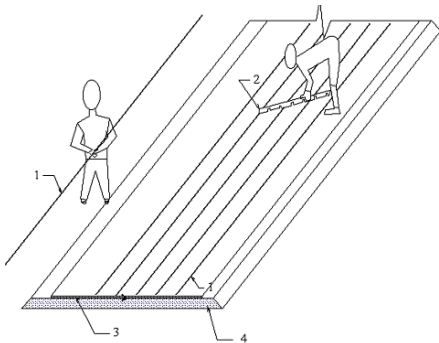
Укладання подовжніх арматурних стрижнів:
